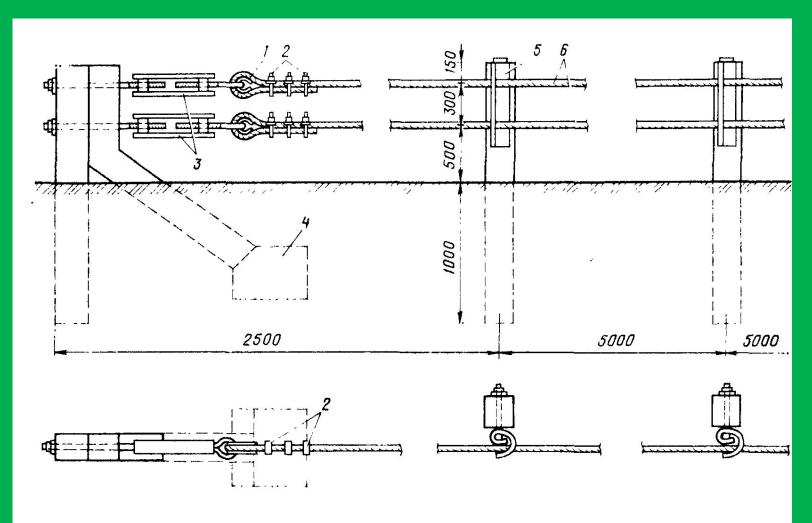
Ограждение из стальных тросов, закрепленных через амортизаторы на же-лезобетонных стойках:
